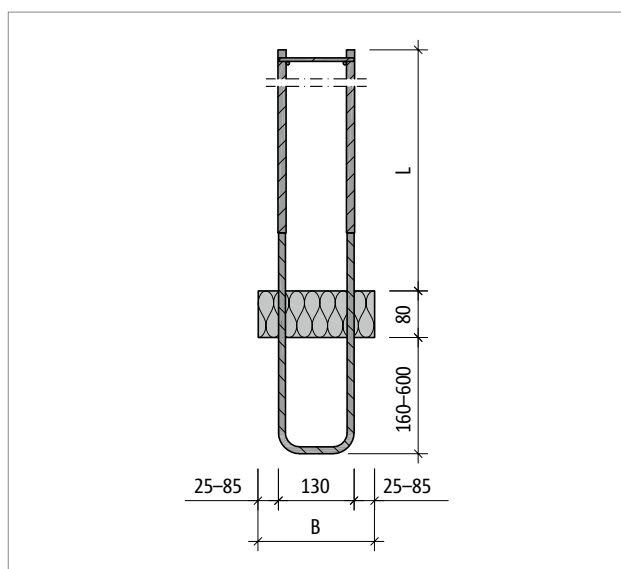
Schöck Sconnex® type W-T2-BW : coupe A-A du produit
